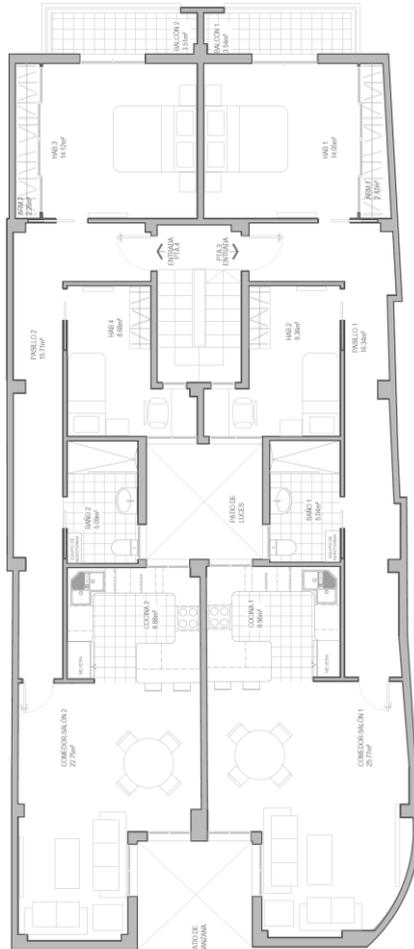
Plano de distribución reformado. 2022. Fuente propia
